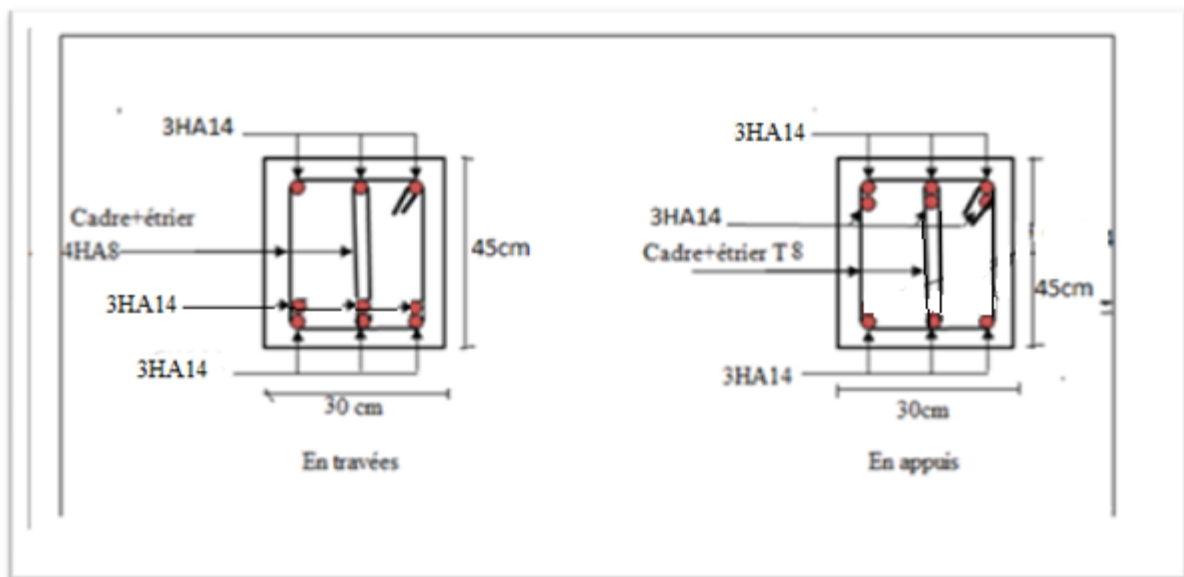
schéma de ferrailage poutres secondaires étage 09 et 10
